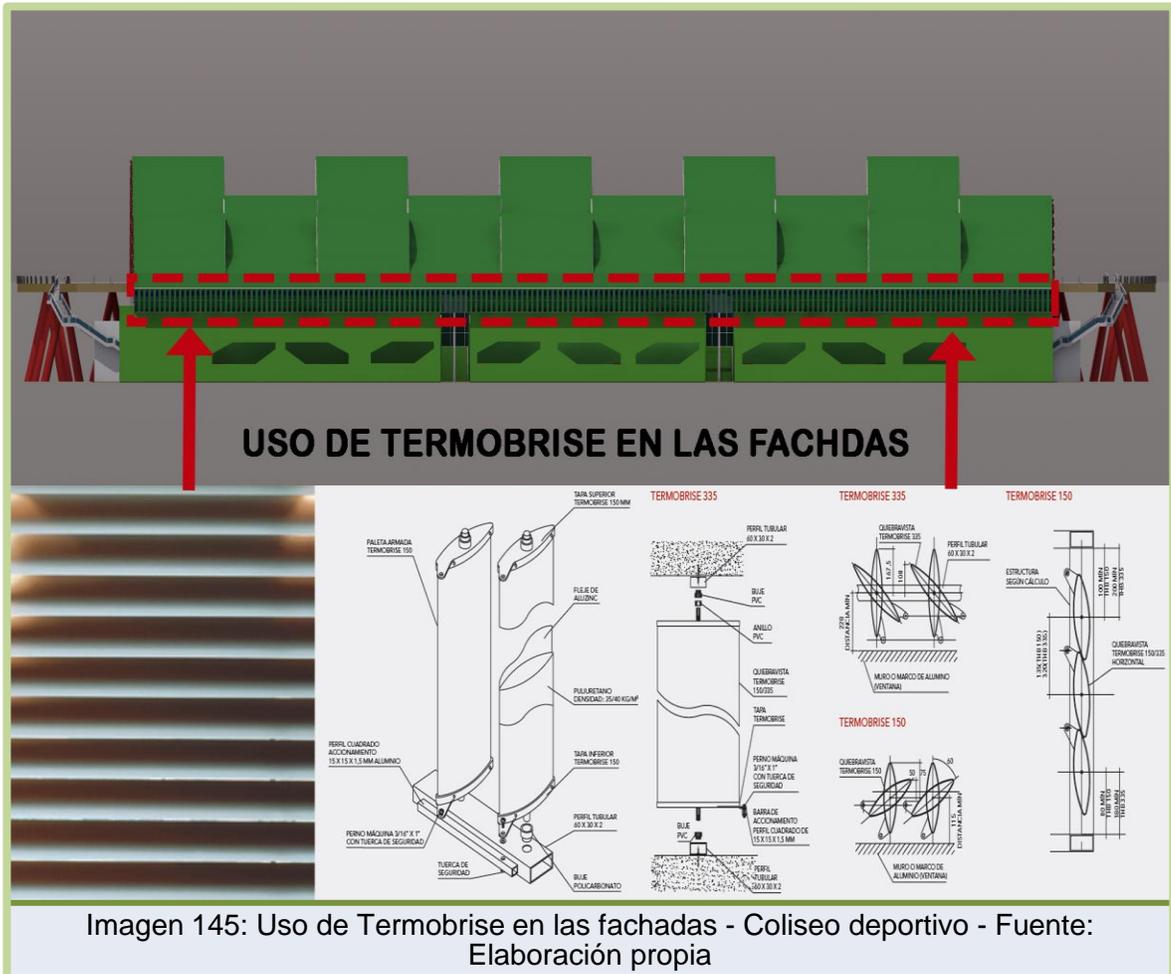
Uso de Termobrise en las fachadas - Coliseo deportivo - Fuente: Elaboración propia
